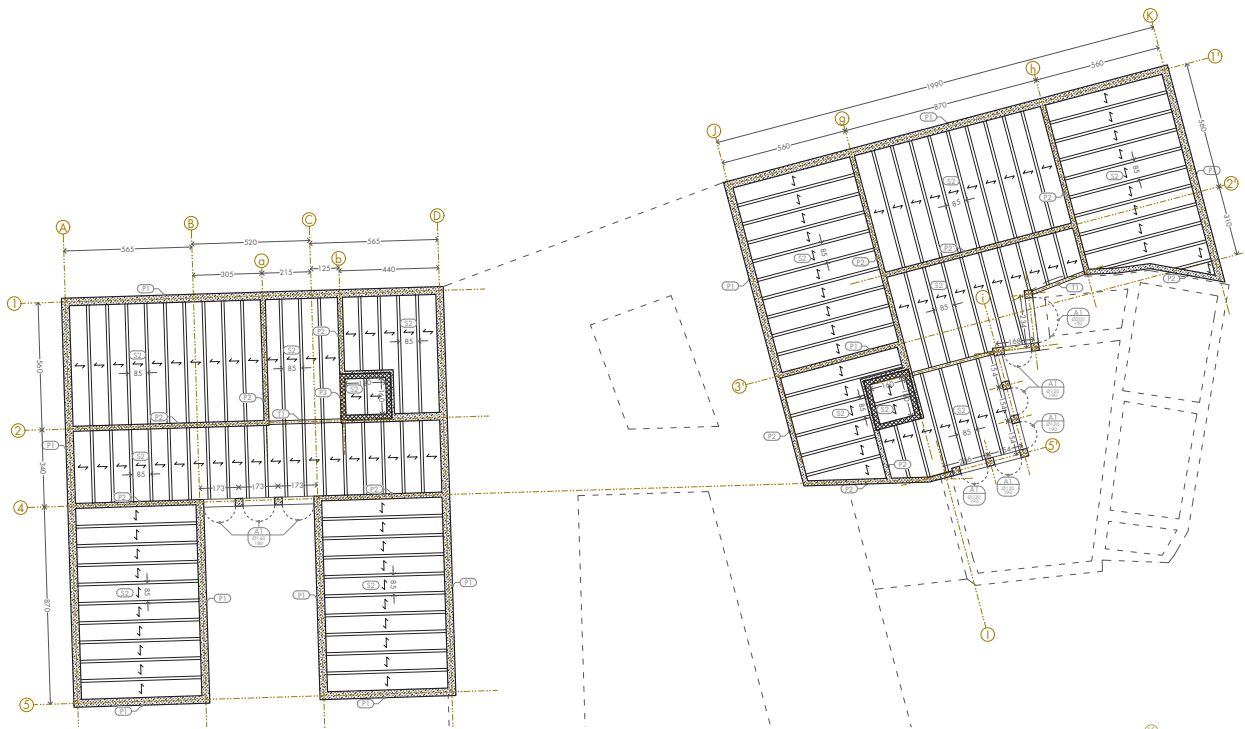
Pianta strutturale delle secondo impalco. Scala 1/300
